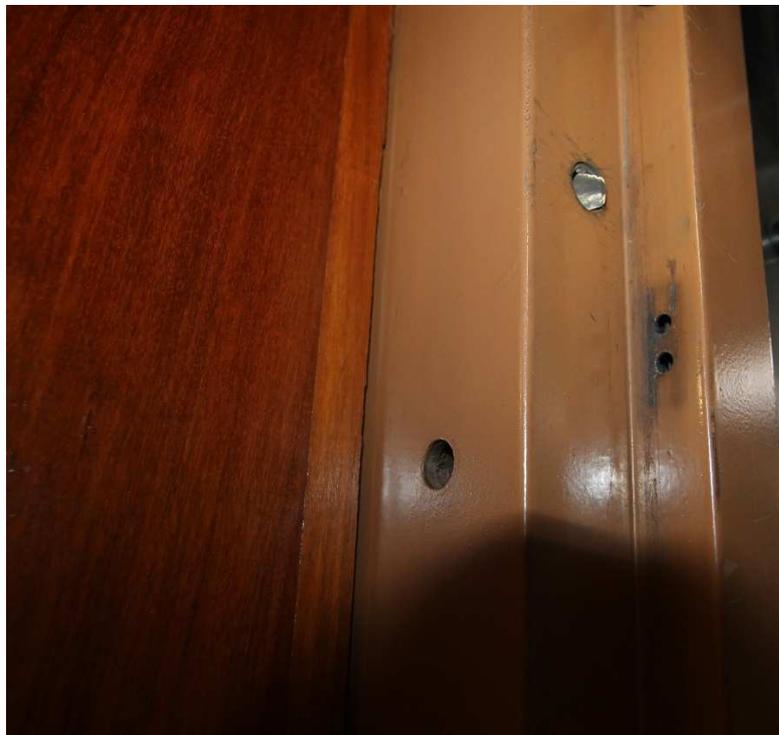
Detalhe, trava de abertura da porta de pavimento, nos elevadores sociais. Esse mecanismo deve ser substituído por outro, que dificulte a abertura por leigos
